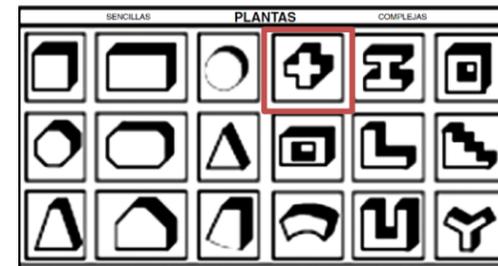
Tipo de conceptos para plantas arquitectónicas de hospitales
